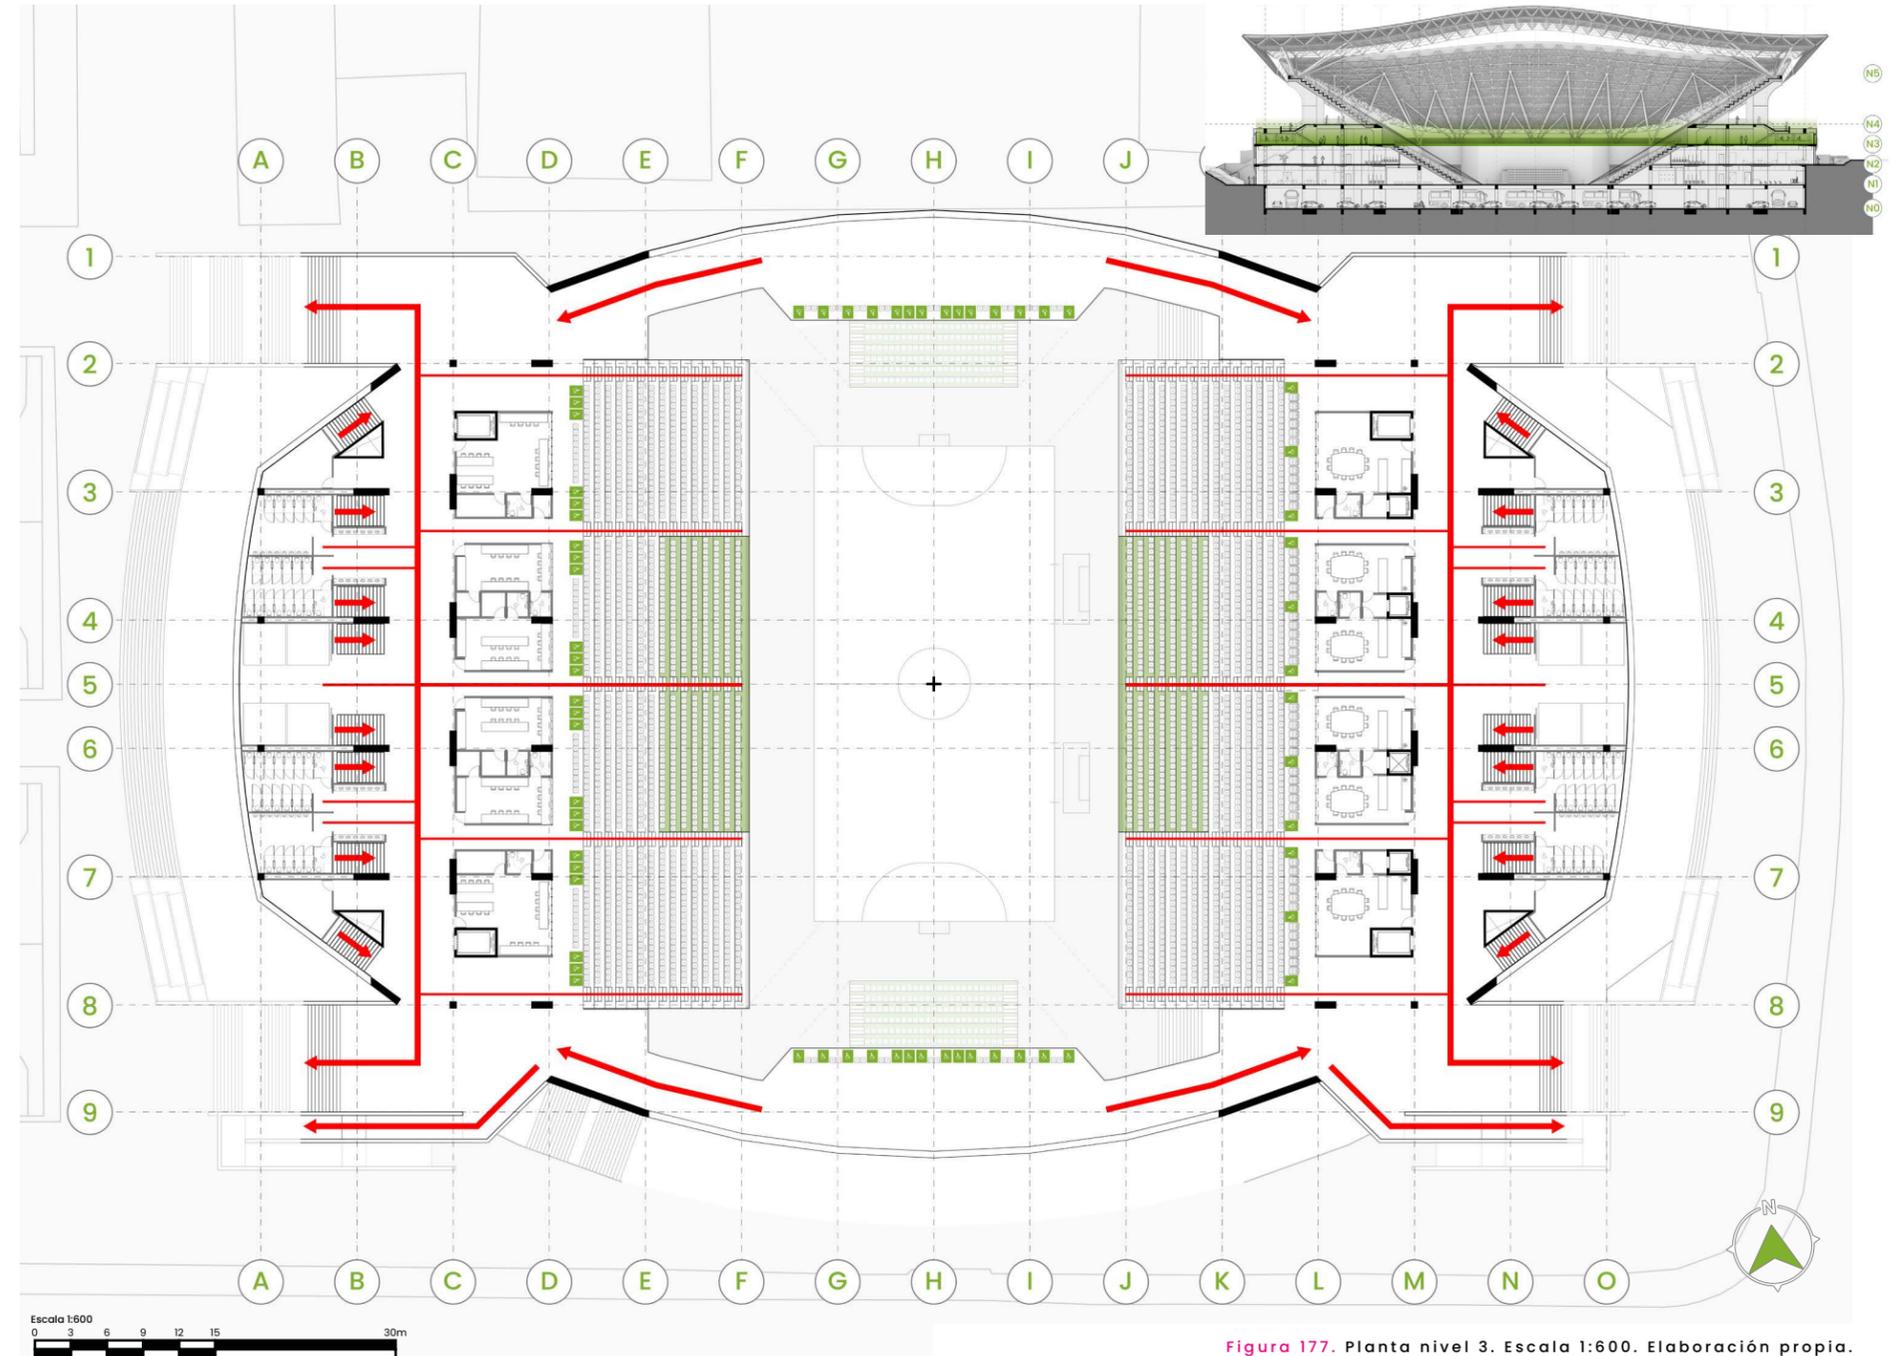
Planta nivel 3. Escala 1:600. Elaboración propia.
